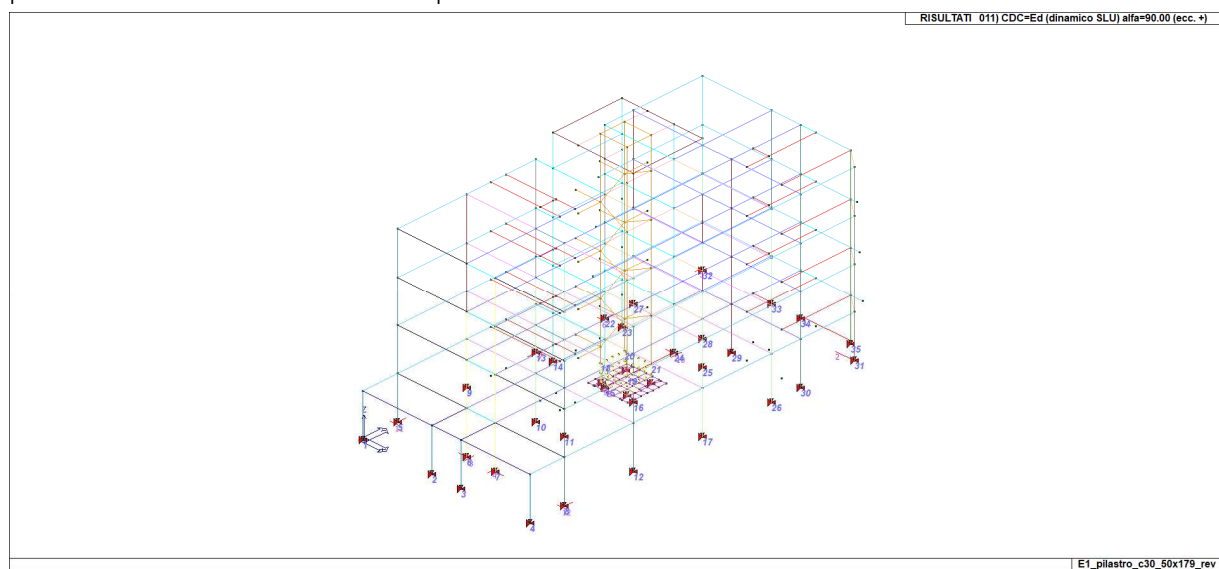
Vista assonometrica unifilare con numerazione pilastri
